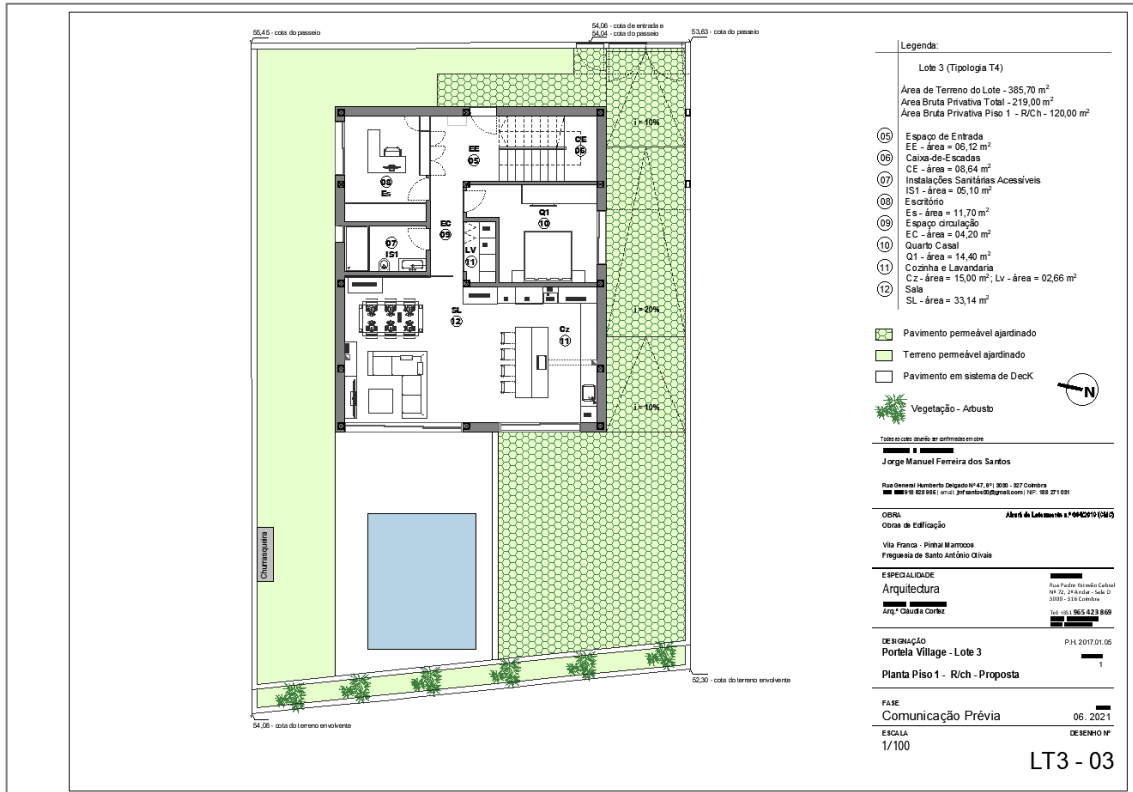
Planta baixa cedida pela construtora primeiro pavimento - Projeto JH. Fonte: Acervo FBN
